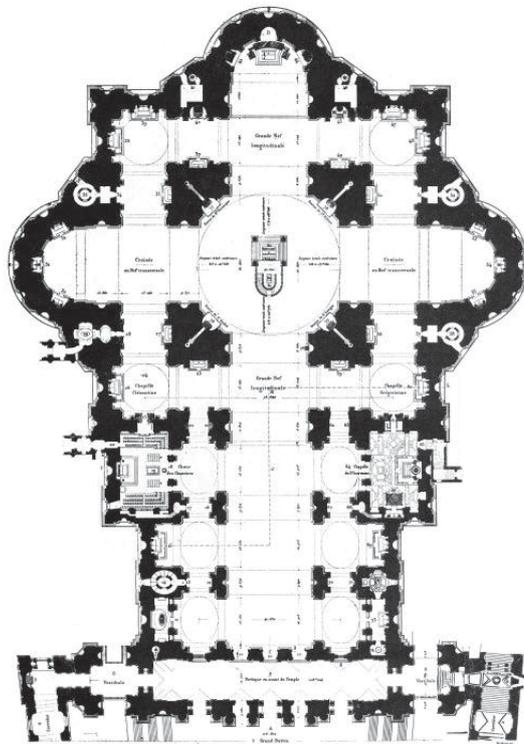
Grundriss Petersdom, Carlo Maderno, 1607
